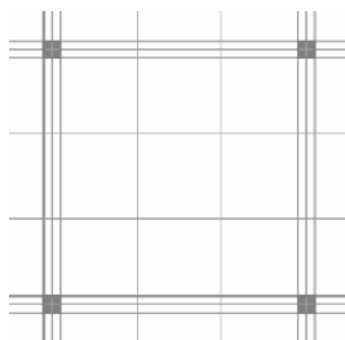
Lajes com cabos em disposição mista [adaptado de B2]
